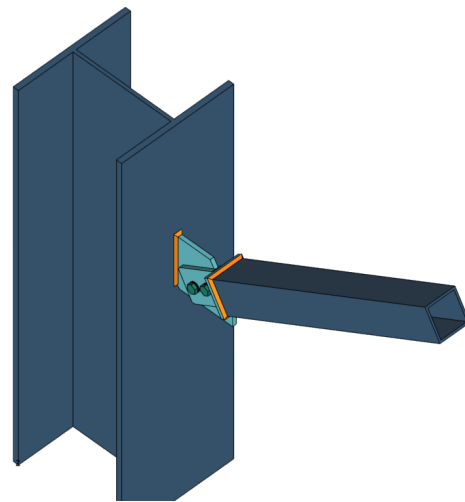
Articulacion poteau-barre de contreventement en tube carré avec chape sur gousset
